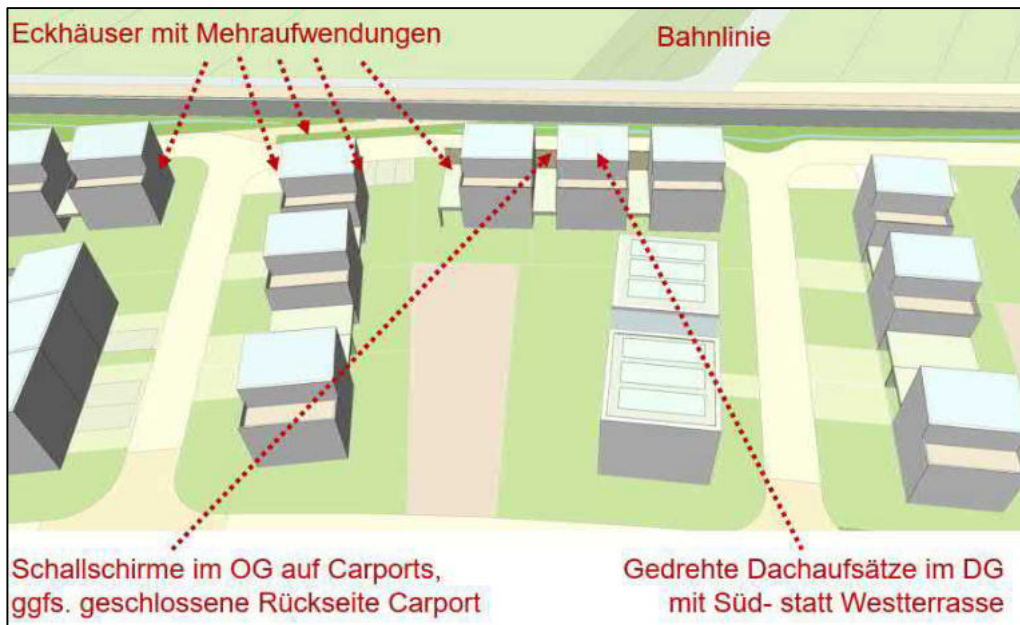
Beispielhafte lärmoptimierte Grundrissgestaltung mit integrierten baulichen Maßnahmen¹
